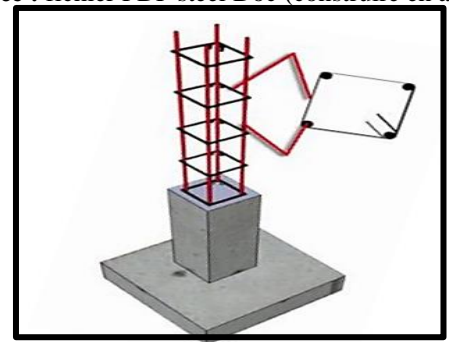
Section poteaux béton armé Source : <https://structatis.com/guides/etude-beton-arme>
